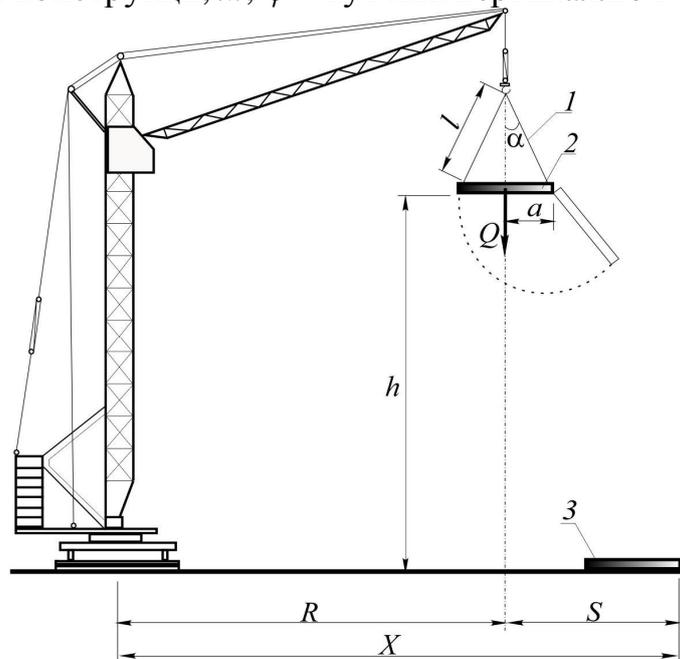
Визначення межі небезпечної зони при падінні будівельної конструкції з крюка крана:
